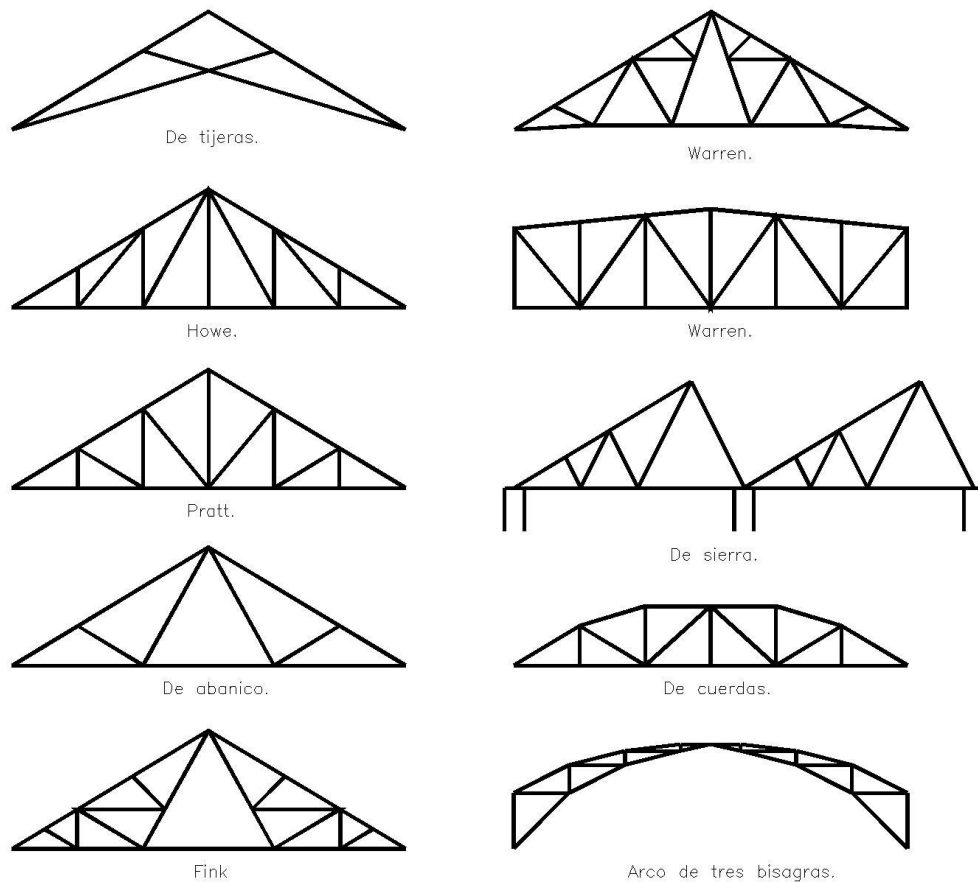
Ejemplo de diversos tipos de armadura para cubiertas.
